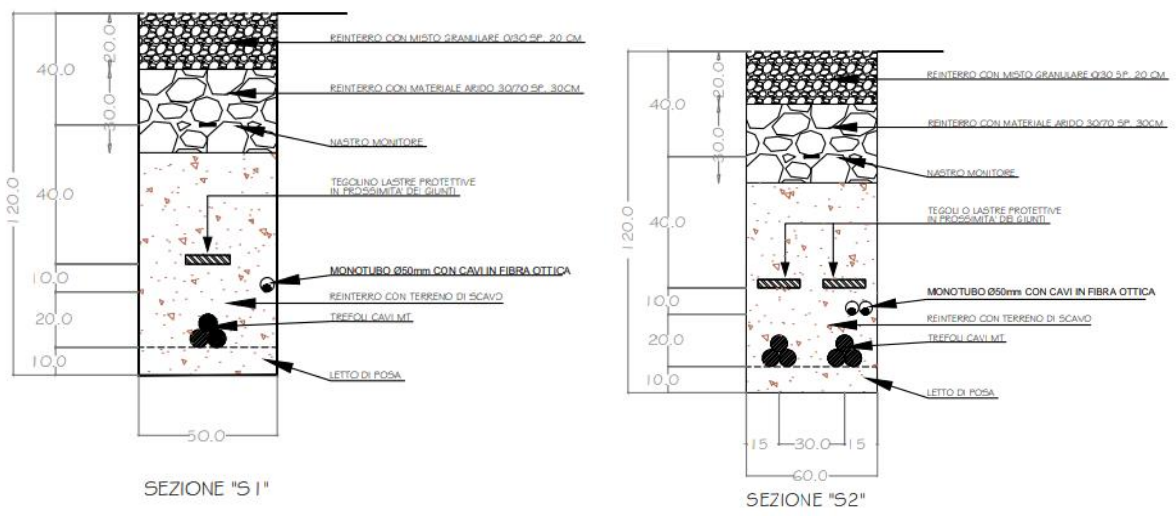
Sezioni per la posa dei cavi MT su strade bianche
